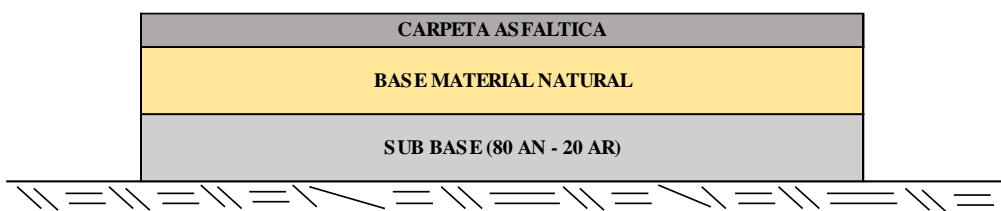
Espesores calculados de pavimento 2 para 10 000 000 EE
